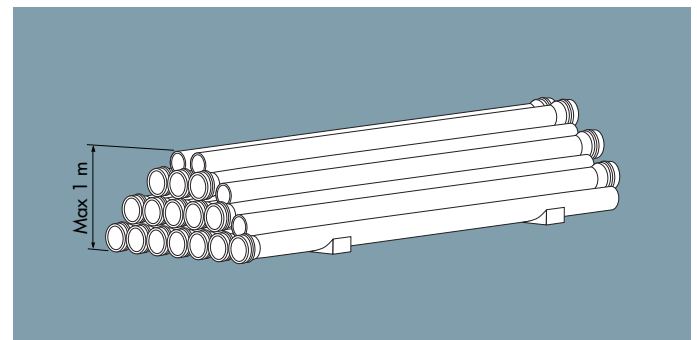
Stoccaggio di tubi in cantiere - Storage of pipes in the building yard
